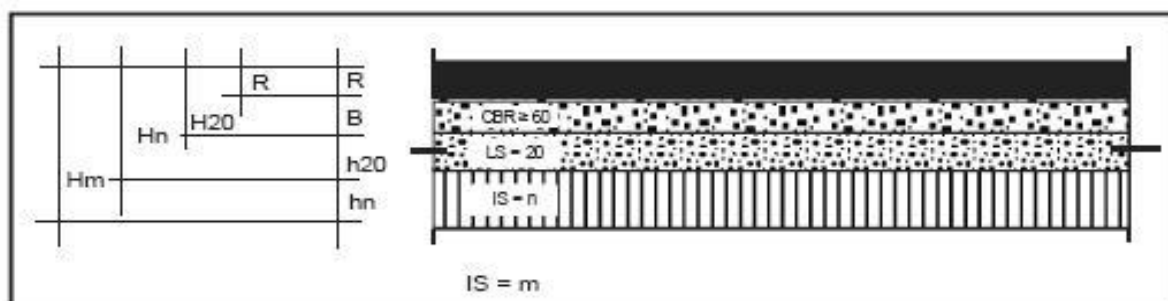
Ábaco de Dimensionamento de Pavimentos (Fonte: Manual de Dimensionamento de Pavimentos do DNIT – 2006)
